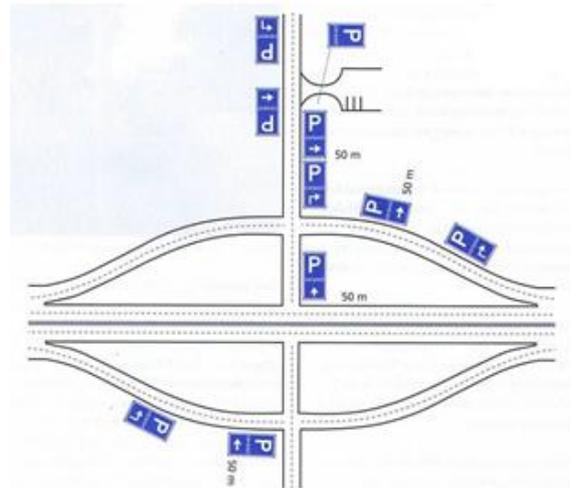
Exemple typique d'un parking de covoiturage bien accessible à la multimodalité
